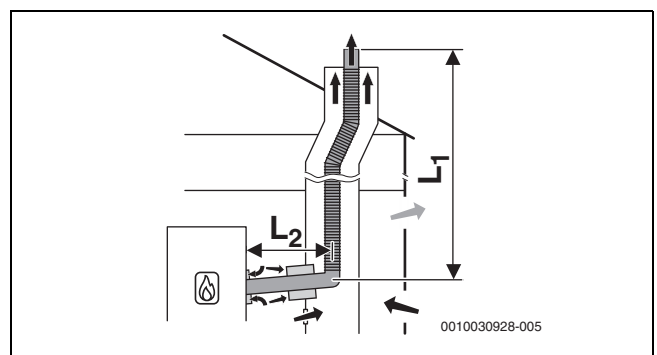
Flexible Abgasführung im Schacht nach B_{53P} mit raumluftabhängiger Luftzufuhr am Gerät und einwandiger Abgasleitung im Aufstellraum; Hinterlüftungsöffnung im Schacht
